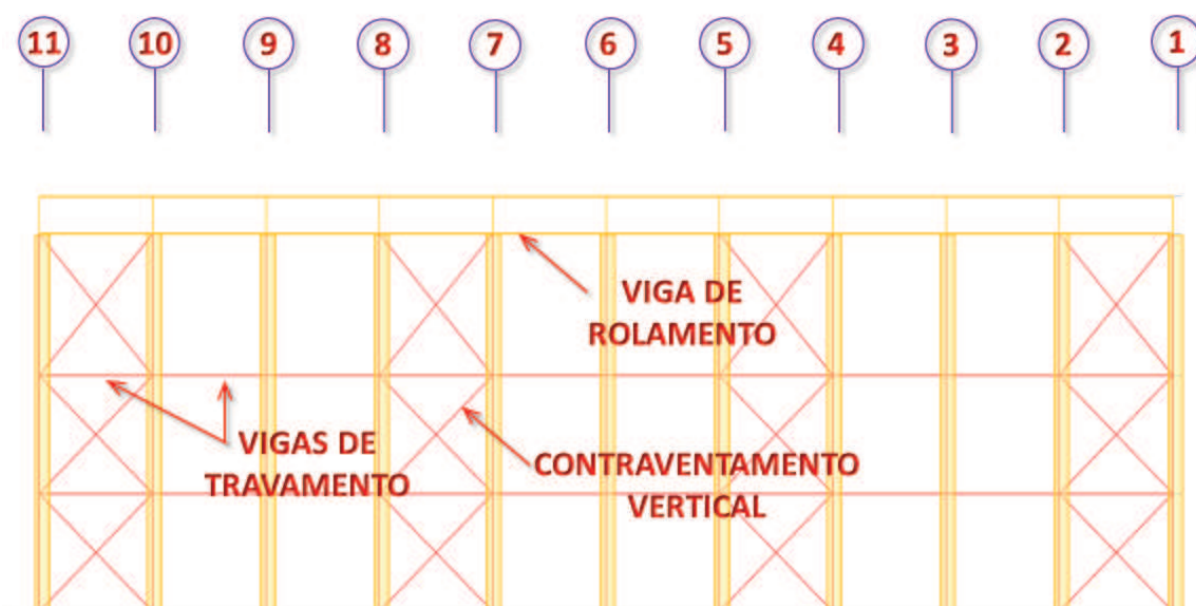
Vista do contraventamento vertical interno e da viga de rolamento.
